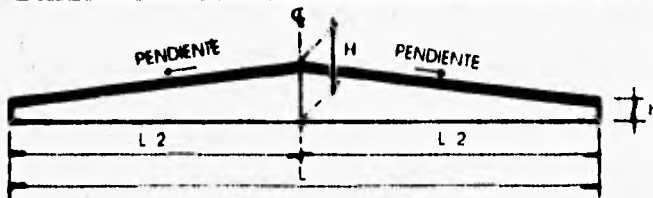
ALTERNATIVAS DE CUBIERTA CON TRABE LOSA TTPV.
